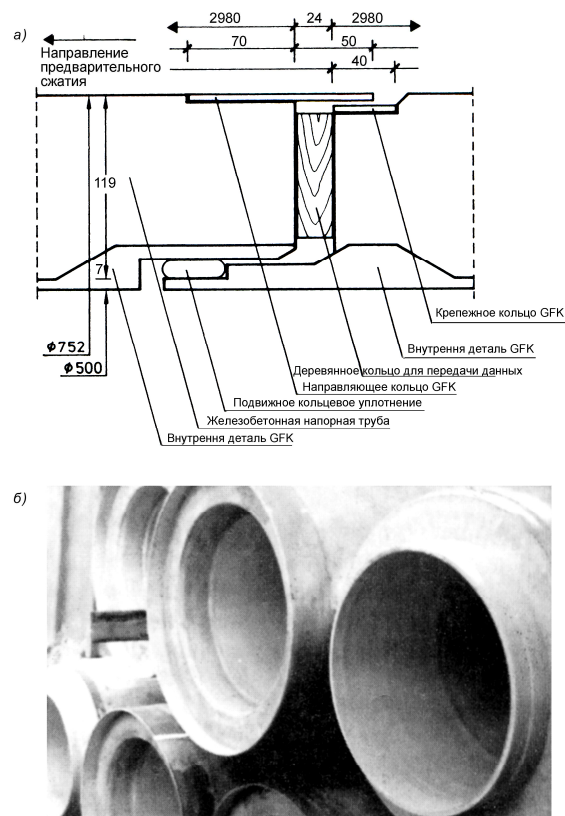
Железобетонная напорная труба с внутренней трубой из полиэтилена высокого давления: а) разрез по соединению; б) общий вид.
